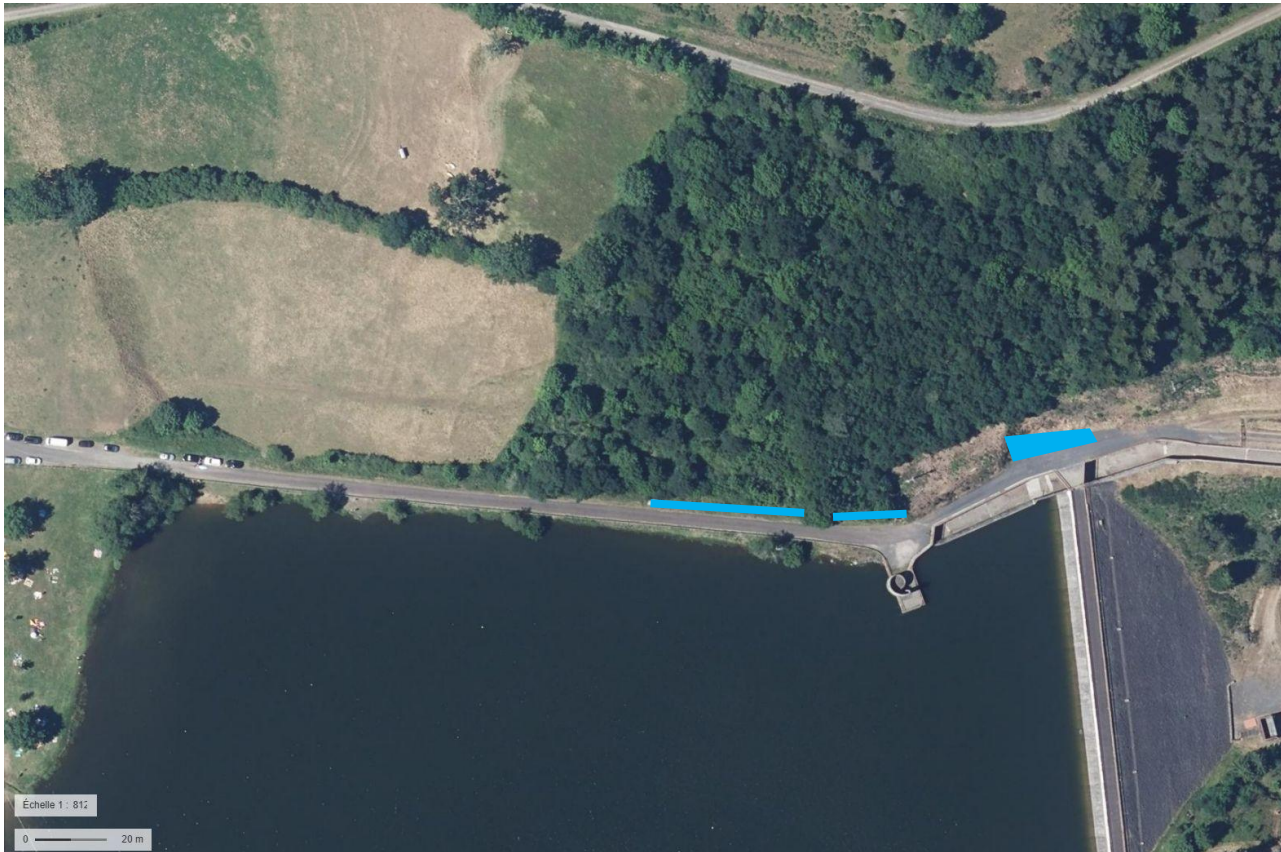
Localisation des installations de chantier (Source : Géoportail)
